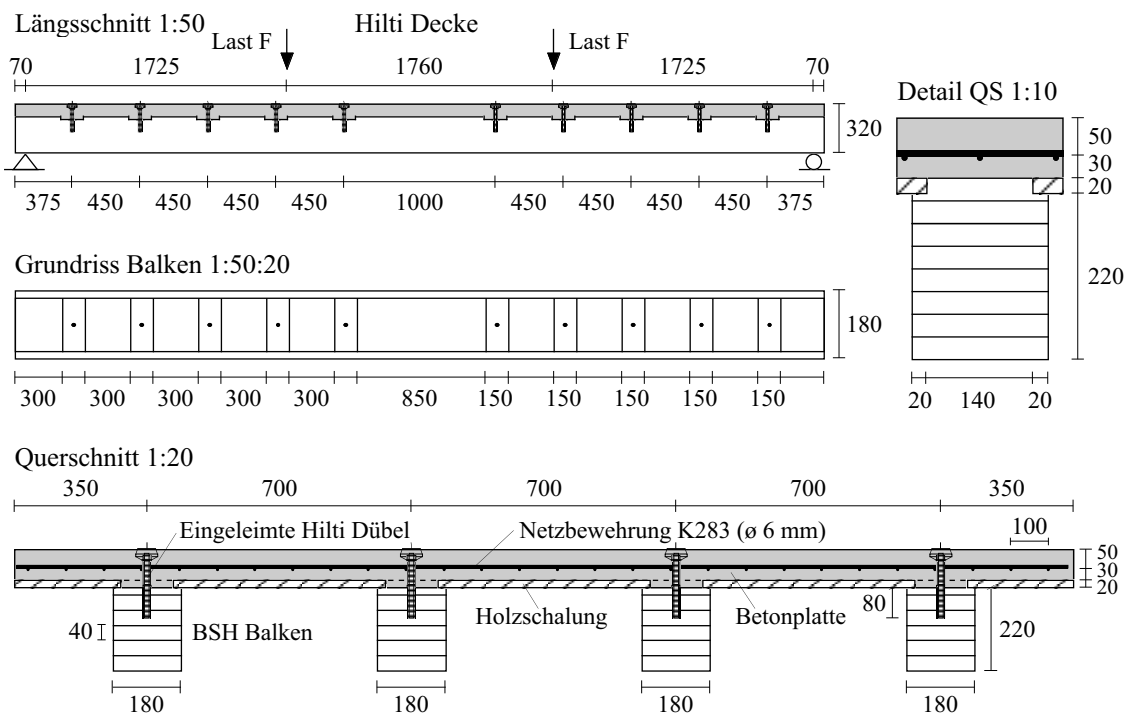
Holz-Beton-Verbunddecken mit Kerben und eingeleimten Dübeln
